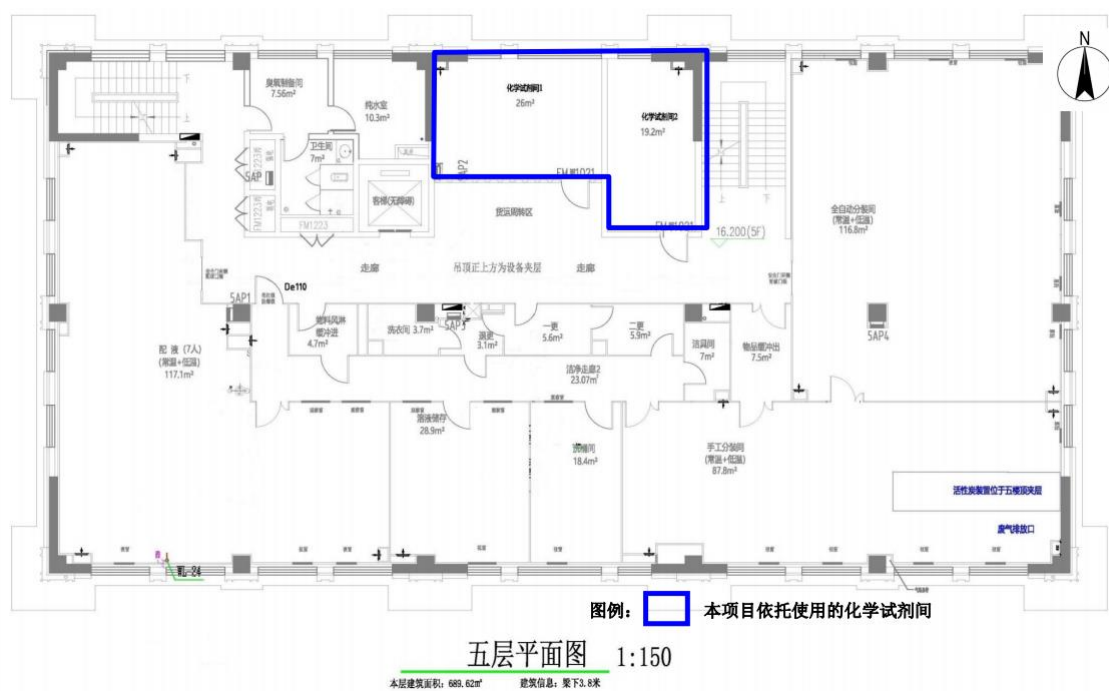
现有工程五层平面布置图（本项目依托化学试剂间）
